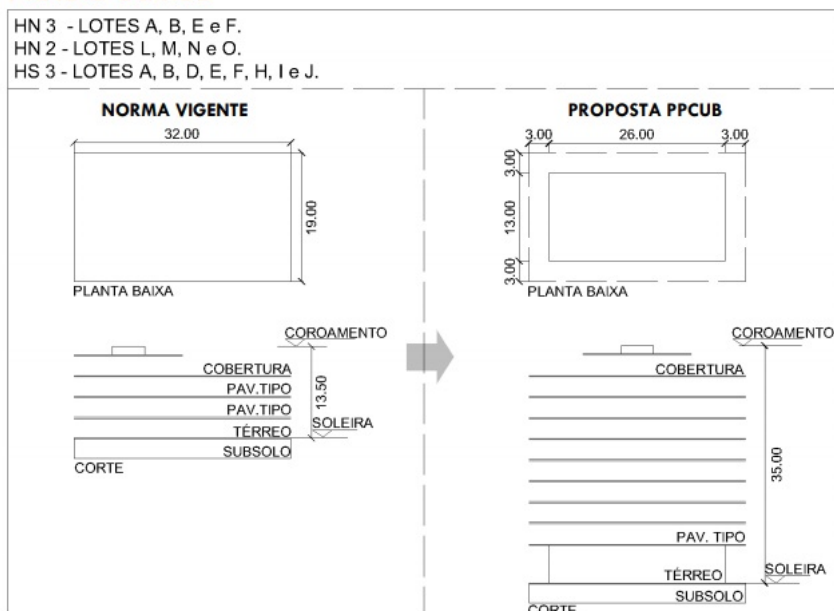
SHN/SHS, tipologia “hotéis baixos”: proposta de alteração de gabarito, com acréscimo de pavimentos (de 4 para 10) e galeria no térreo
